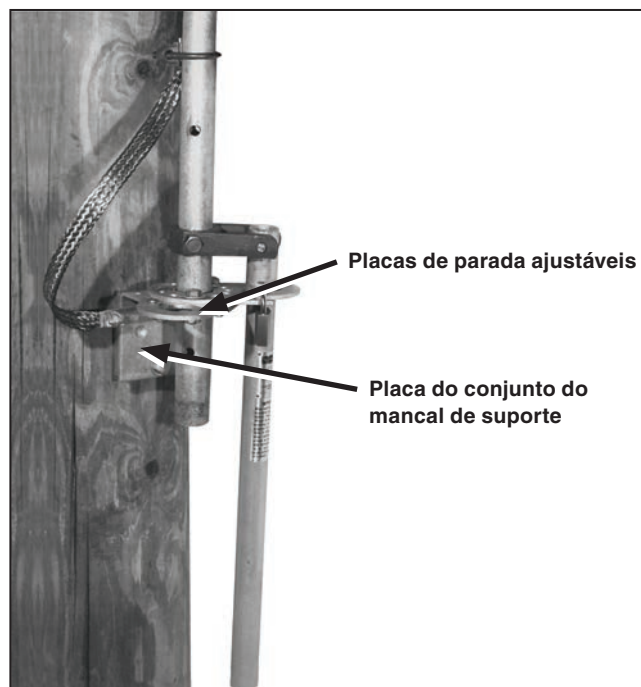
Conjunto de mancal de suporte inferior e conjunto da alavanca de operação.
